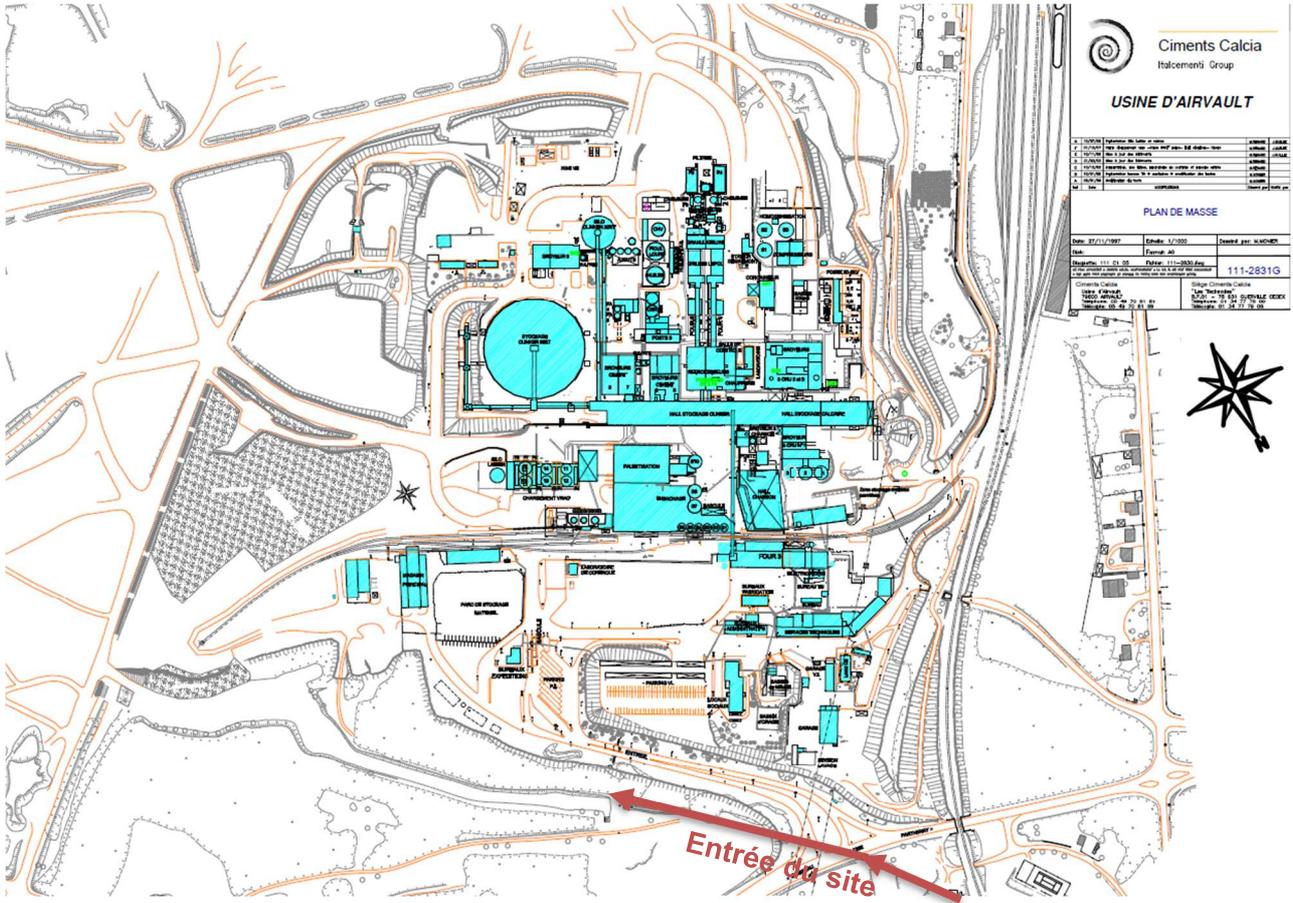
Plan du site avec localisation de l'entrée – Echelle 1/1 000<sup>ème</sup> (Sources : CIMENTS CALCIA)
